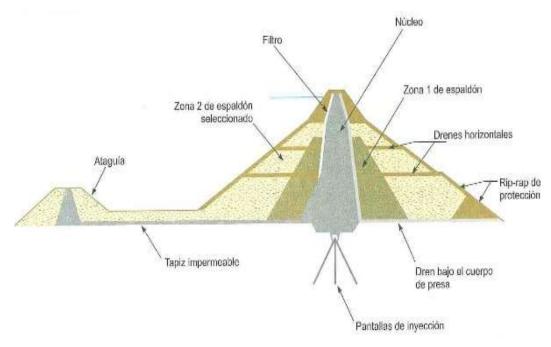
III.1.2.4 Combinación de la estructura de la cortina y el tipo de cimentación.
